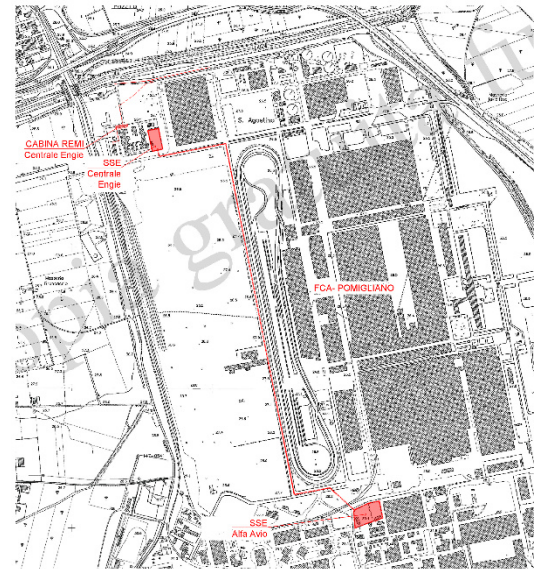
/4 Planimetria percorso di collegamento cavo interrato da 220 kV tra SSE e trasformatore elevatore MT/AT
